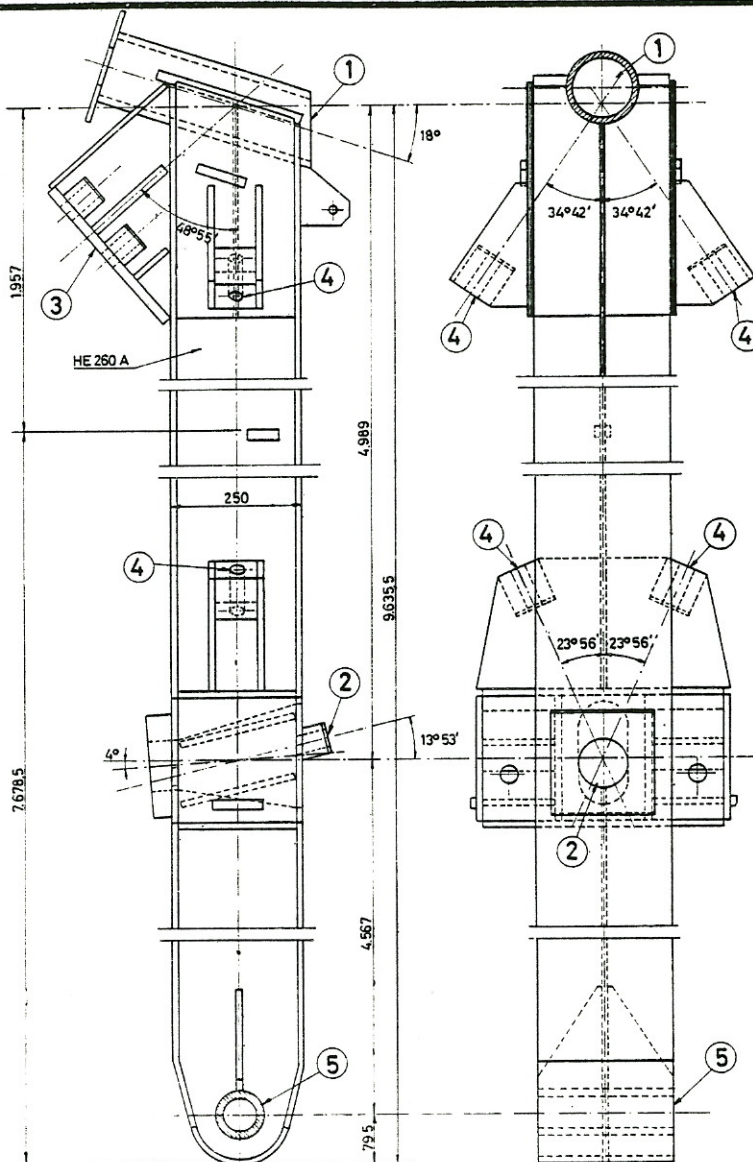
Vista e pianta di un pilastro principale con particolari costruttivi dei dispositivi di collegamento alle estremità degli elementi seguenti: 1. Fune superiore. 2. Fune inferiore. 3. Barre di ancoraggio in direzione dei cavalletti. 4. Barre di controvento nel piano della cerniera. 5. Articolazione alla base.
